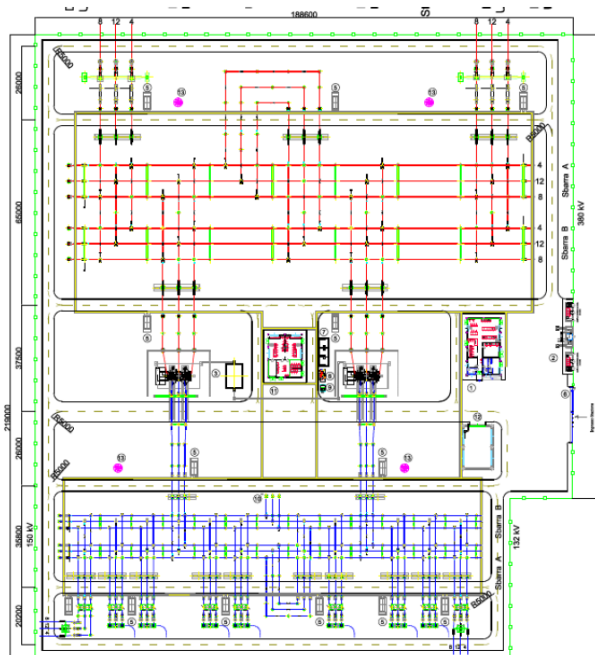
Planimetria generale Stazione da PTO progetto Iberdrola
